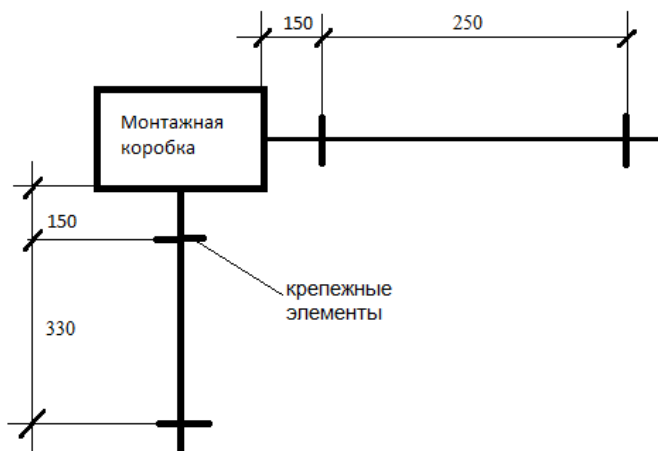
Схема крепления кабеля к основанию при открытой прокладке
